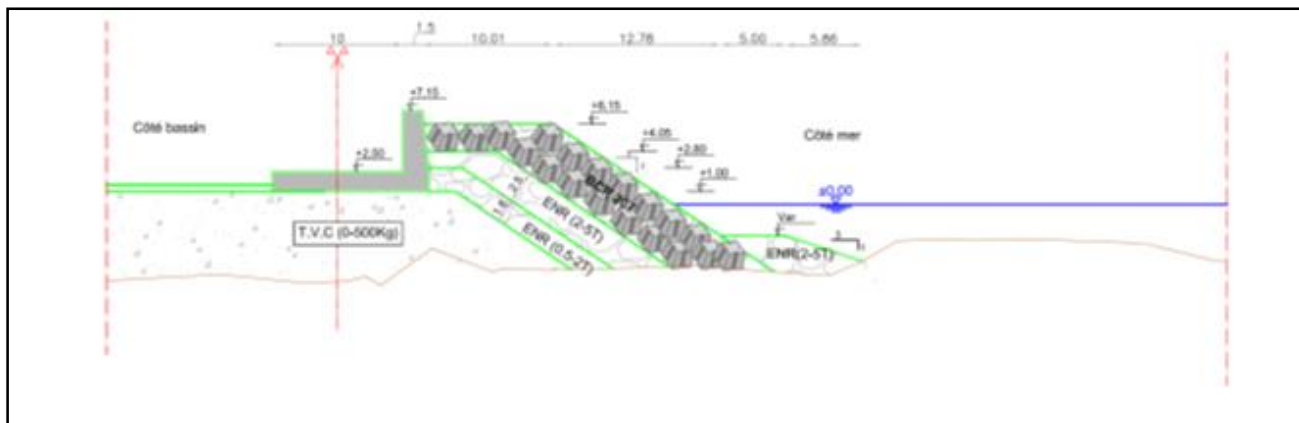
Variante 02 – jetée secondaire- profil courant B (-4m...-7 m)
